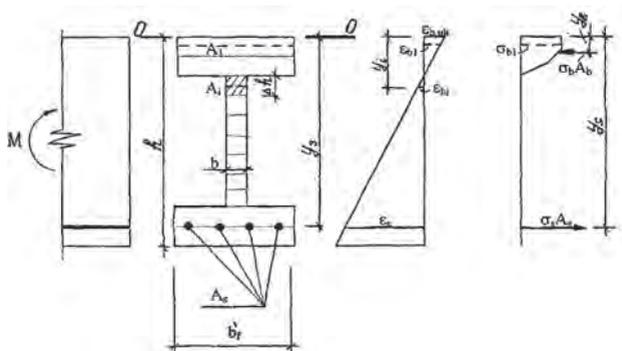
Схемы деформаций, напряжений и усилий в бетоне и арматуре при расчете плит на прочность диаграммным методом.
